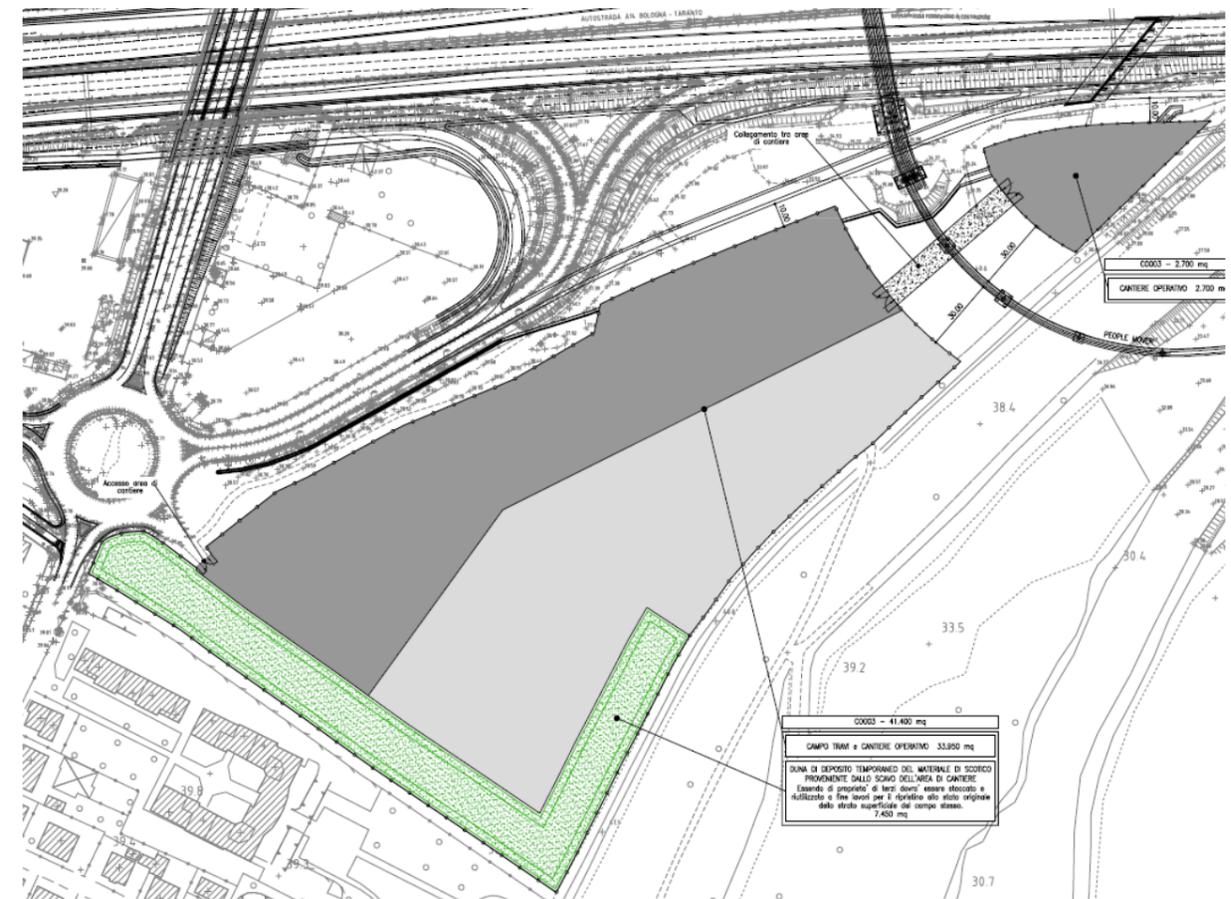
area di cantiere CO03 (estratto tav. CAP0320-0)
